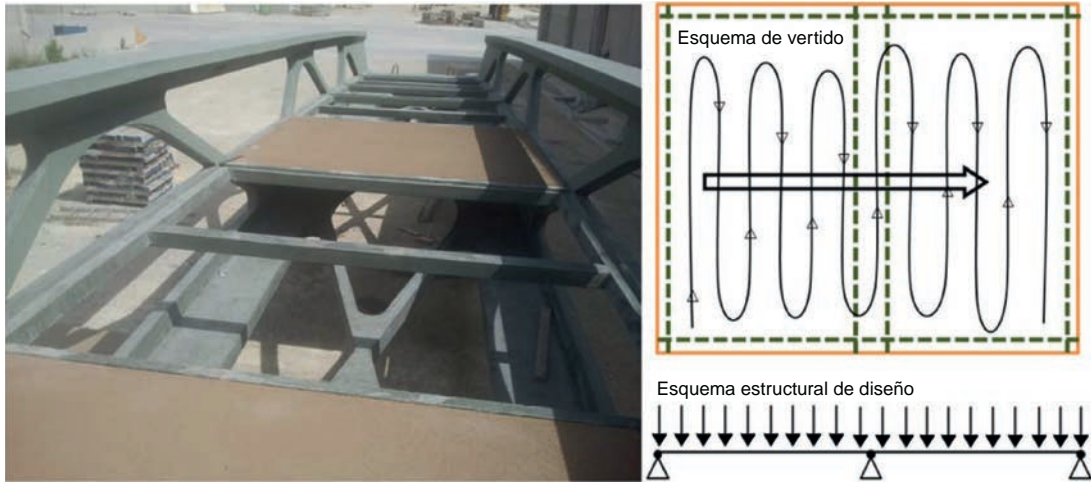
Sistema de apoyo de las losas (izquierda); esquemas de vertido y diseño de las losas (derecha).
